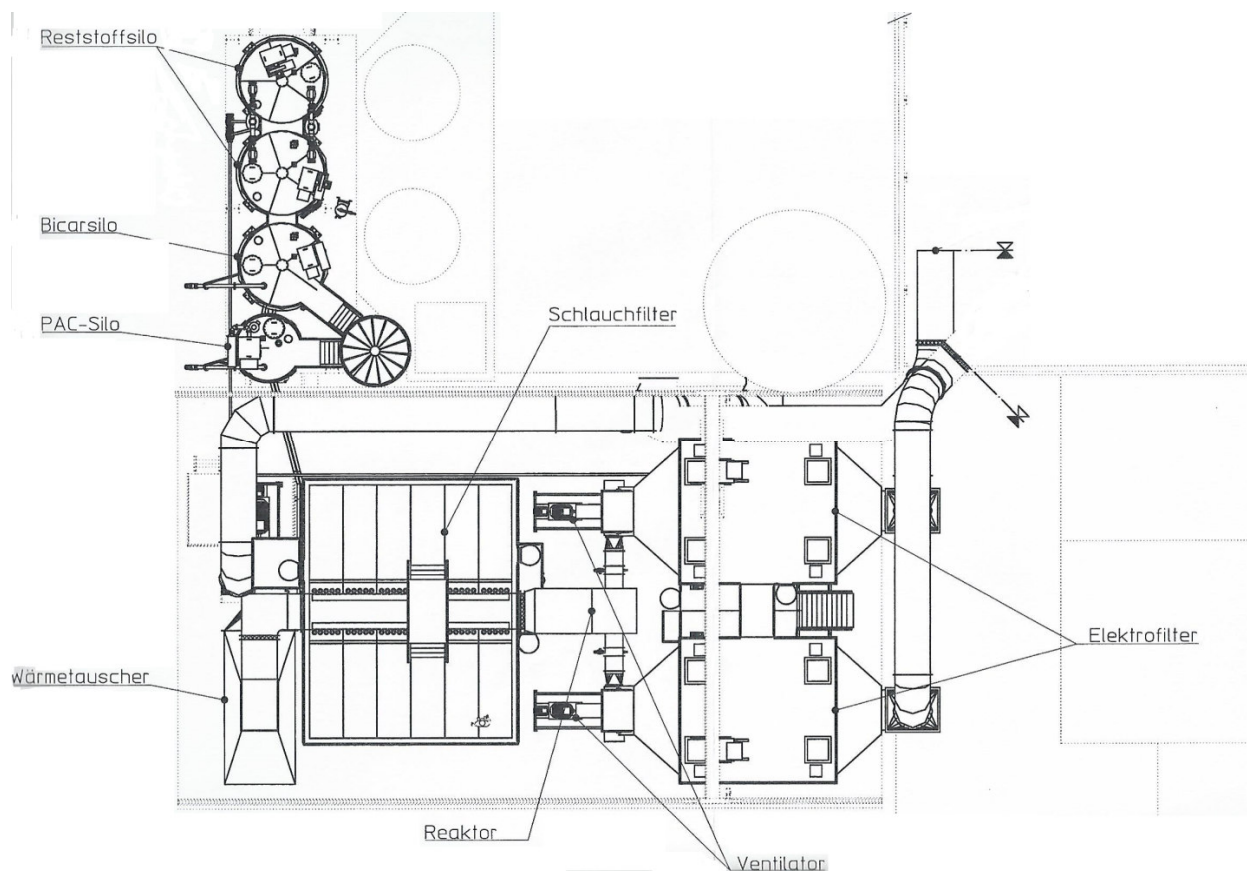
Rauchgasreinigungsanlage, Grundriss
